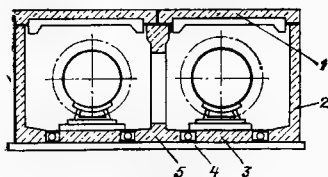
Теплопровод в сборном железобетонном непродоходном канале:
